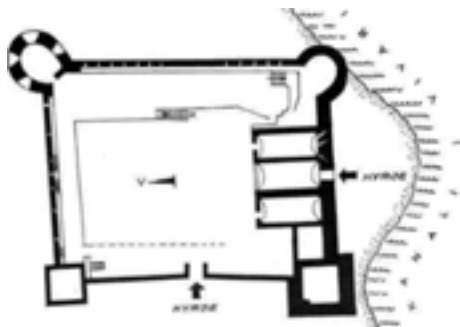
Planimetria della Fortezza rettangolare di Vivari (Istituto dei Monumenti e della Cultura).
